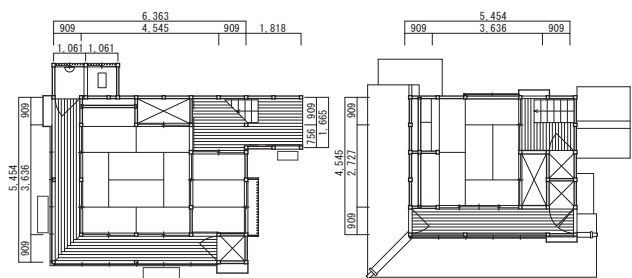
新座敷平面図 1 階（左），2 階（右）
